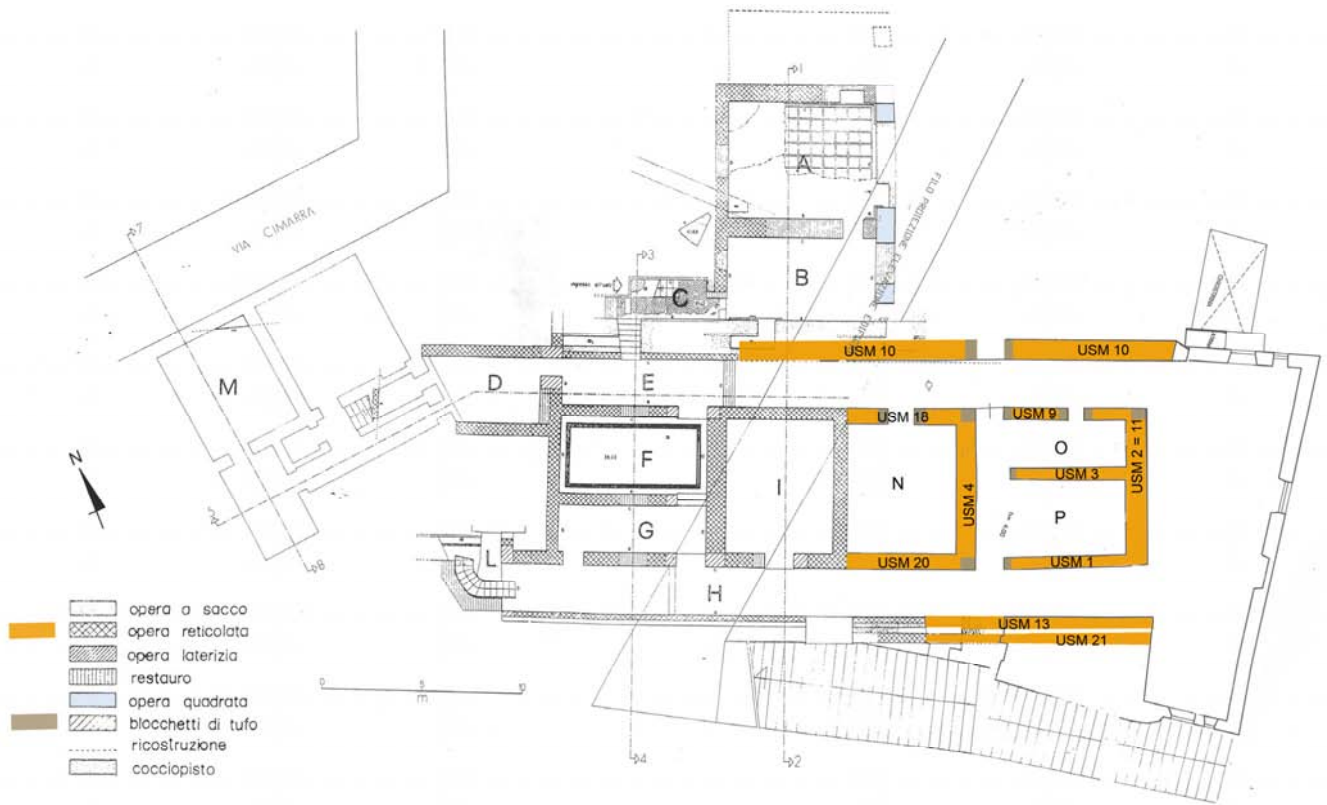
Planimetria generale sovrapposta alle strutture e alle vie di epoca moderna. In senape e giallo le murature indagate nel 2007.
